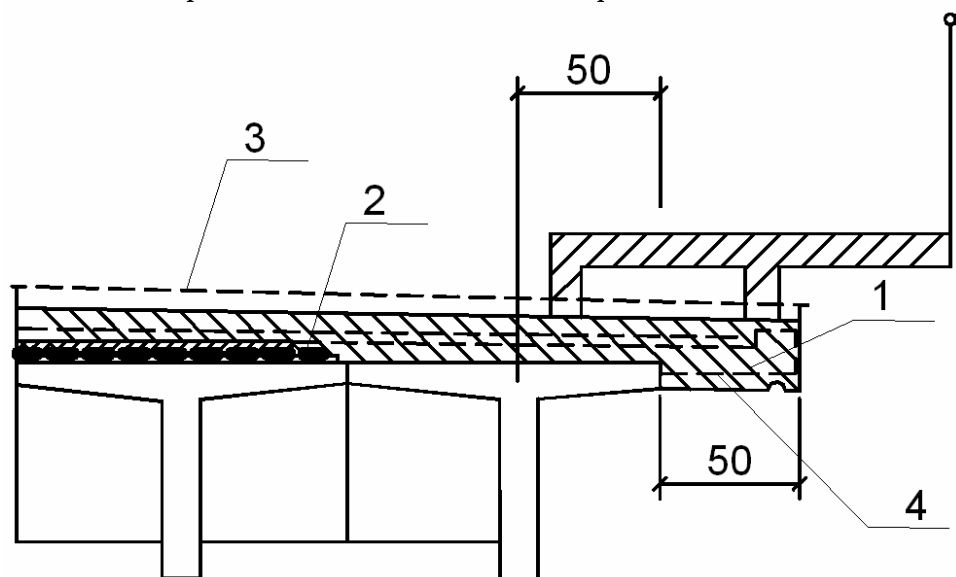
Уширение габарита за счет удлинения тротуарных консолей: 1- монолитный бетон удлинения консоли; 2- граница обрубки старых слоев дорожной одежды; 3- новый слой одежды
